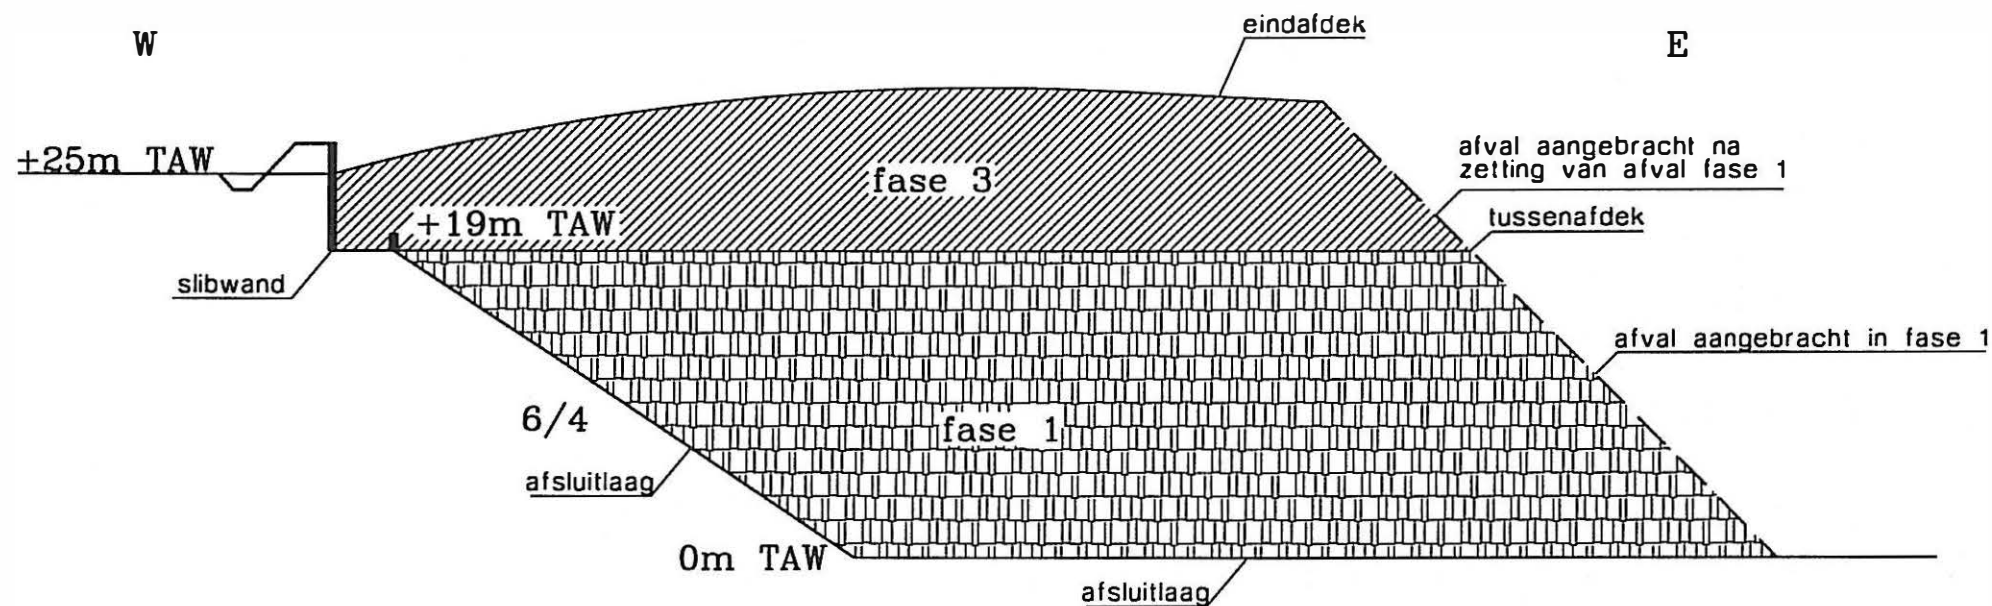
SCHEMATISCHE VOORSTELLING CONSTRUCTIE ZIJAFDICHTING
